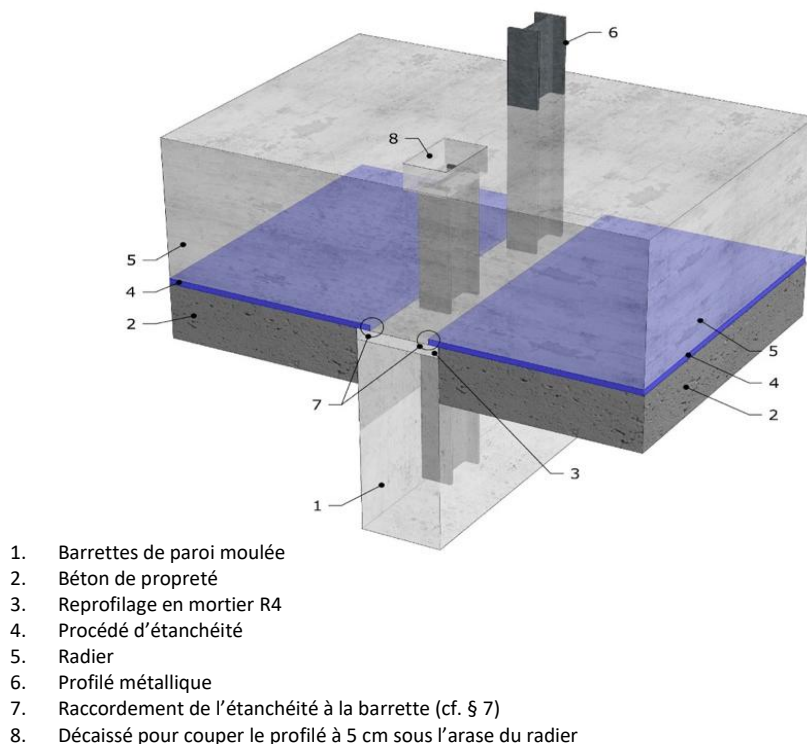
Raccordement sur barrette de paroi moulée avec profilés métalliques
